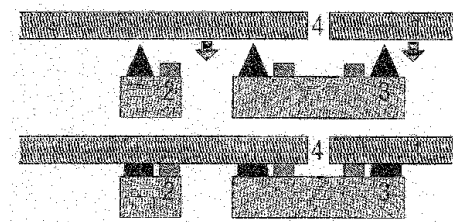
Type doorsnede voor verlijming
